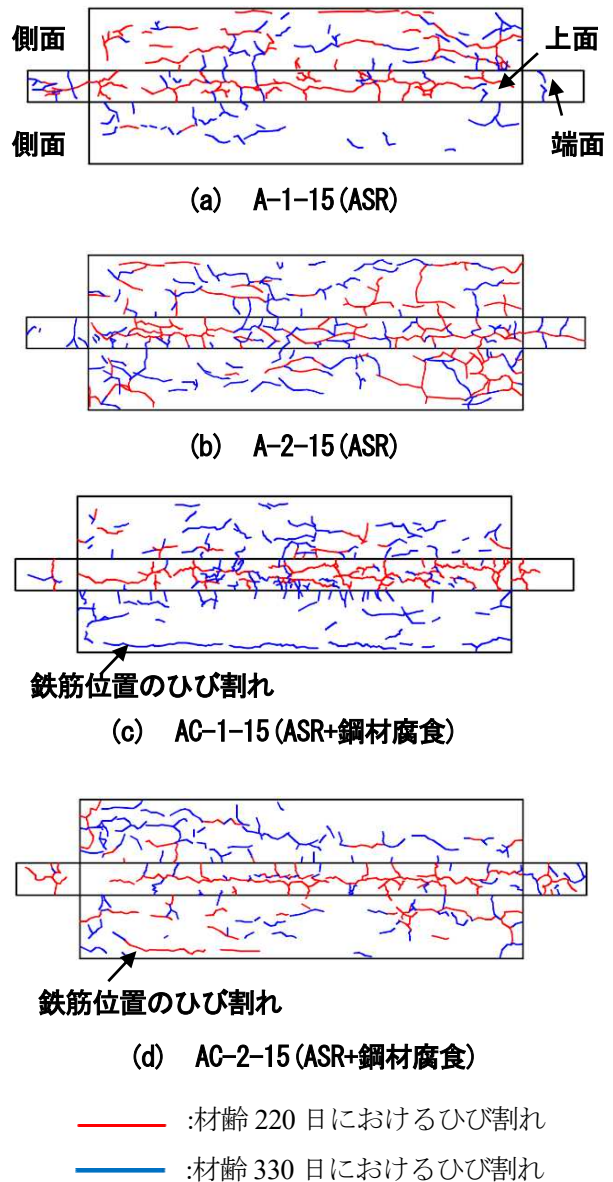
载荷試験前のはり供試体のひび割れ状況
